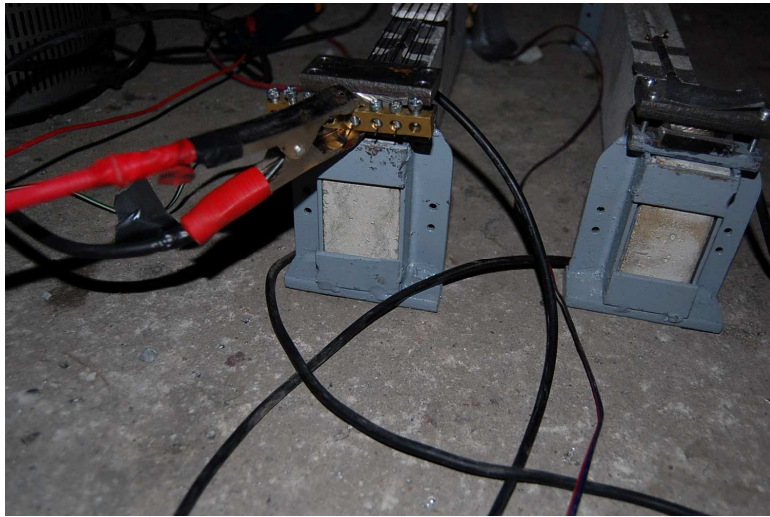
Poutrelle prête pour l'essai (à gauche) et son témoin (à droite).
